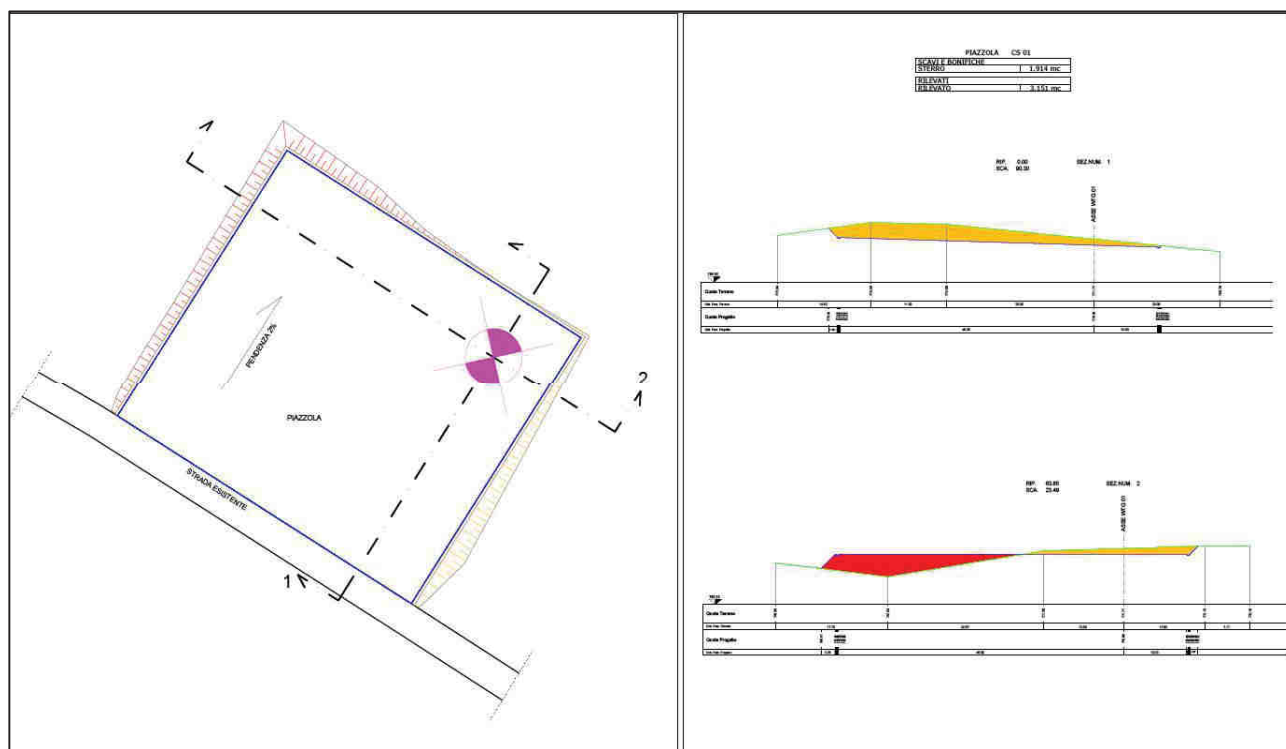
Pianta e sezioni Piazzola CS01 (fase di cantiere) con relativi scavi (arancione) e riporti (rosso).
